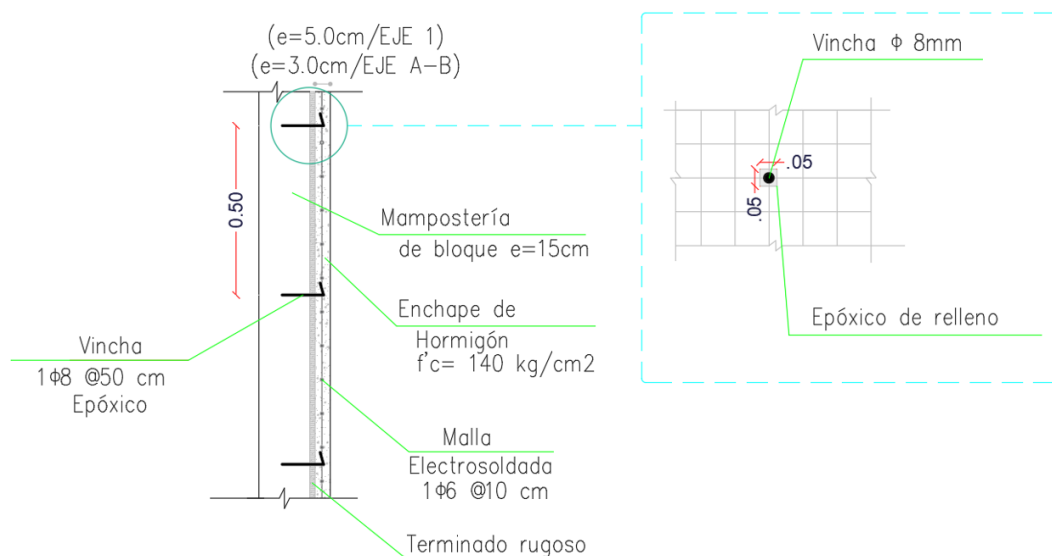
Detalle enchape a una cara, vista frontal de vinchas. Fuente: los autores
